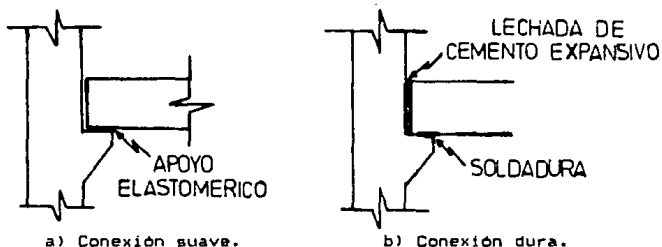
Detalles de conexión entre viga y columna.
